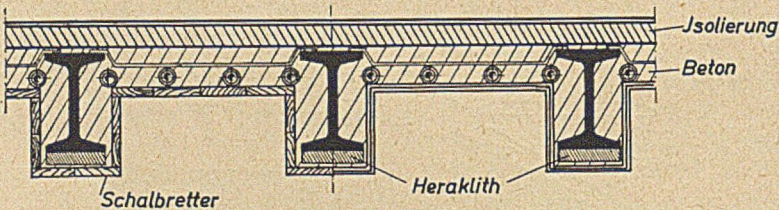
Decke in Stahlkonstruktion mit sichtbaren Unterzügen.
